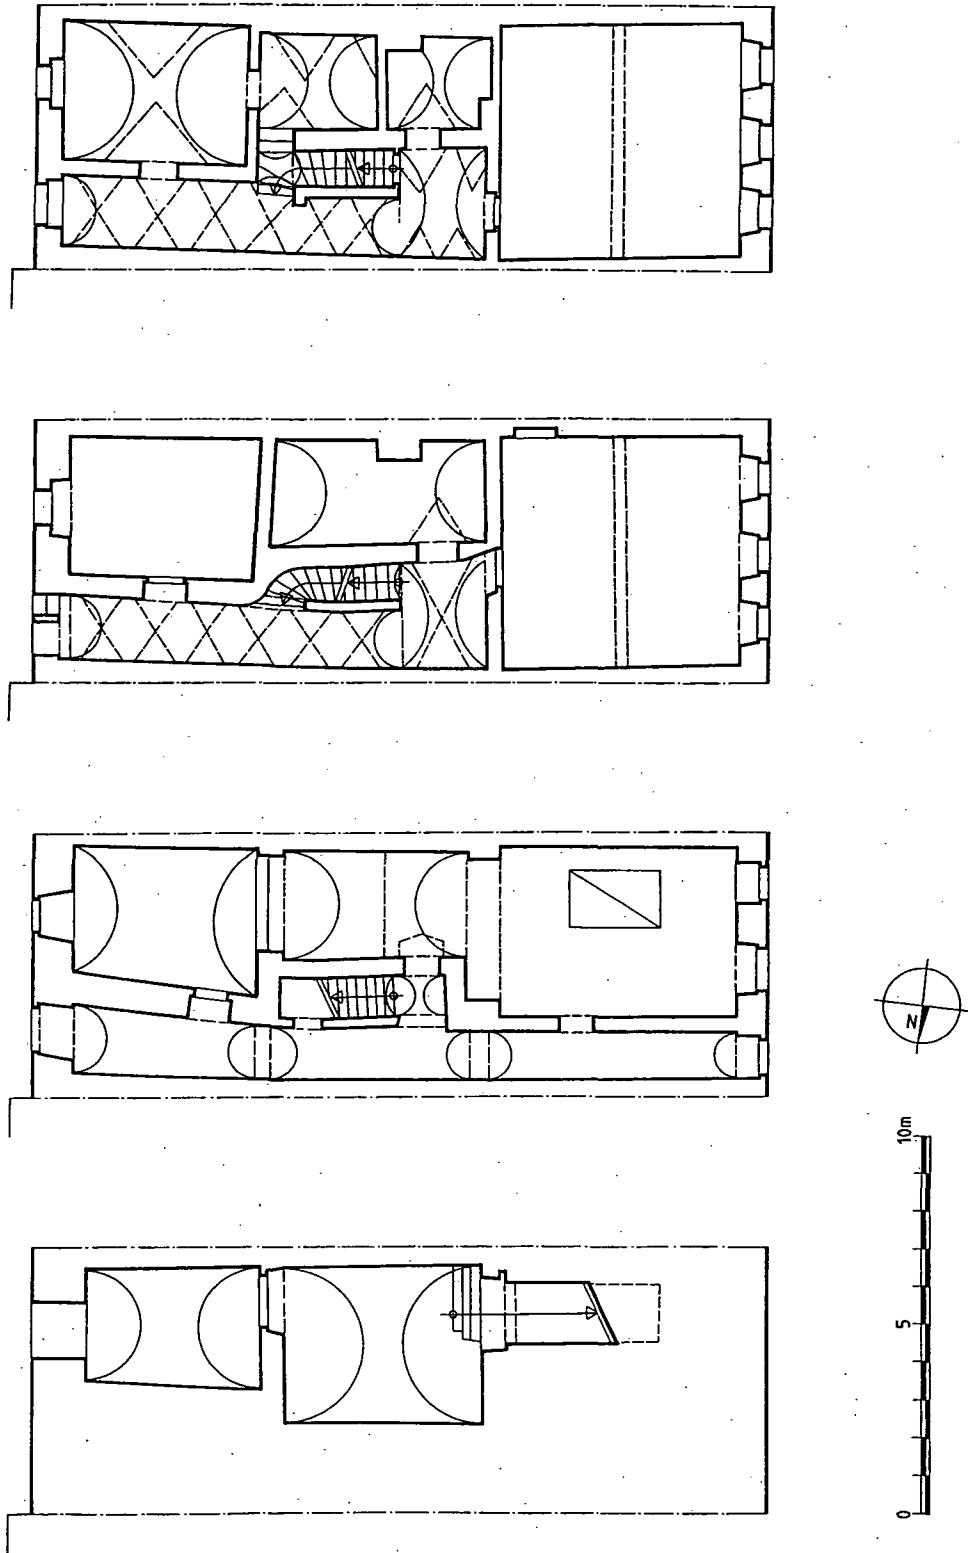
Stadtplatz 10 – Grundrisse Keller, Erdgeschoss, 1. und 2. Obergeschoss (1:200).
